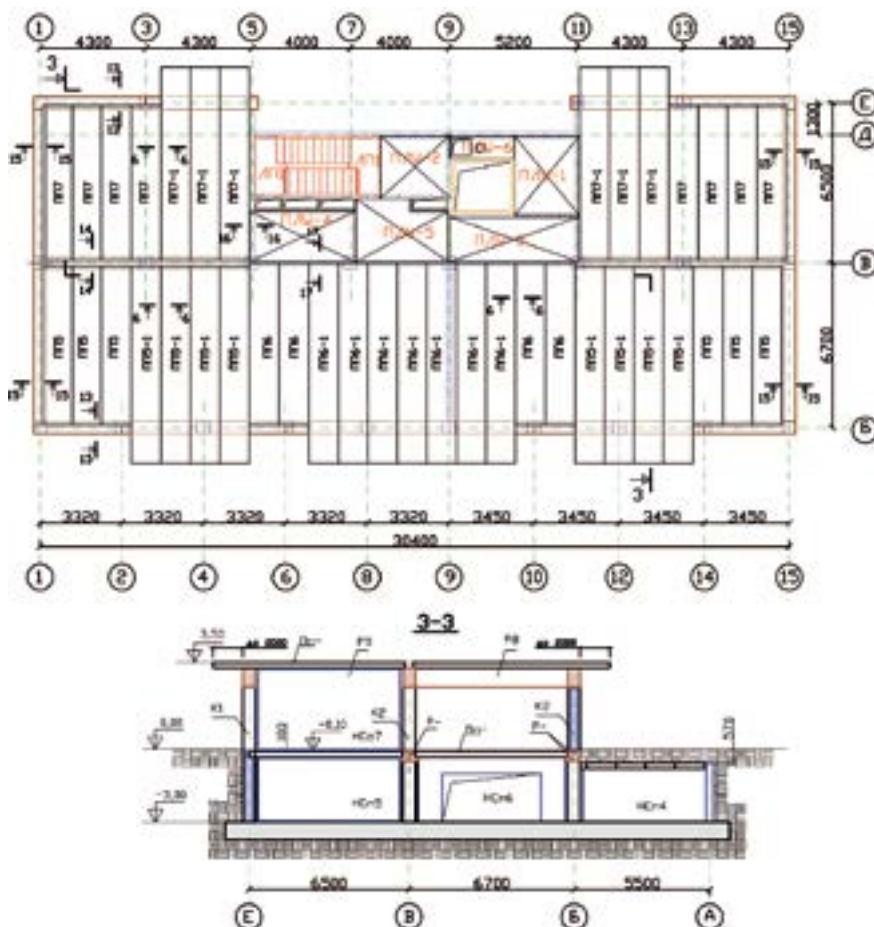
План перекрытия над первым этажом рядовой блок-секции широтной и меридиональной ориентации
